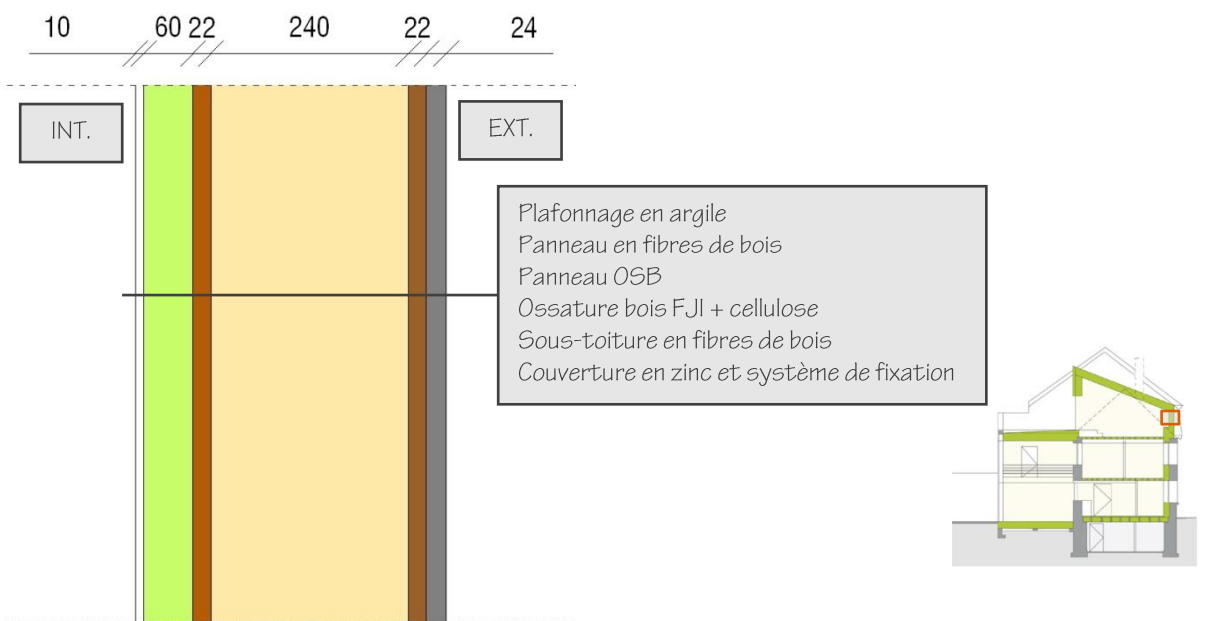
Détail de la rehausse de la façade avant, mesures en [mm]
